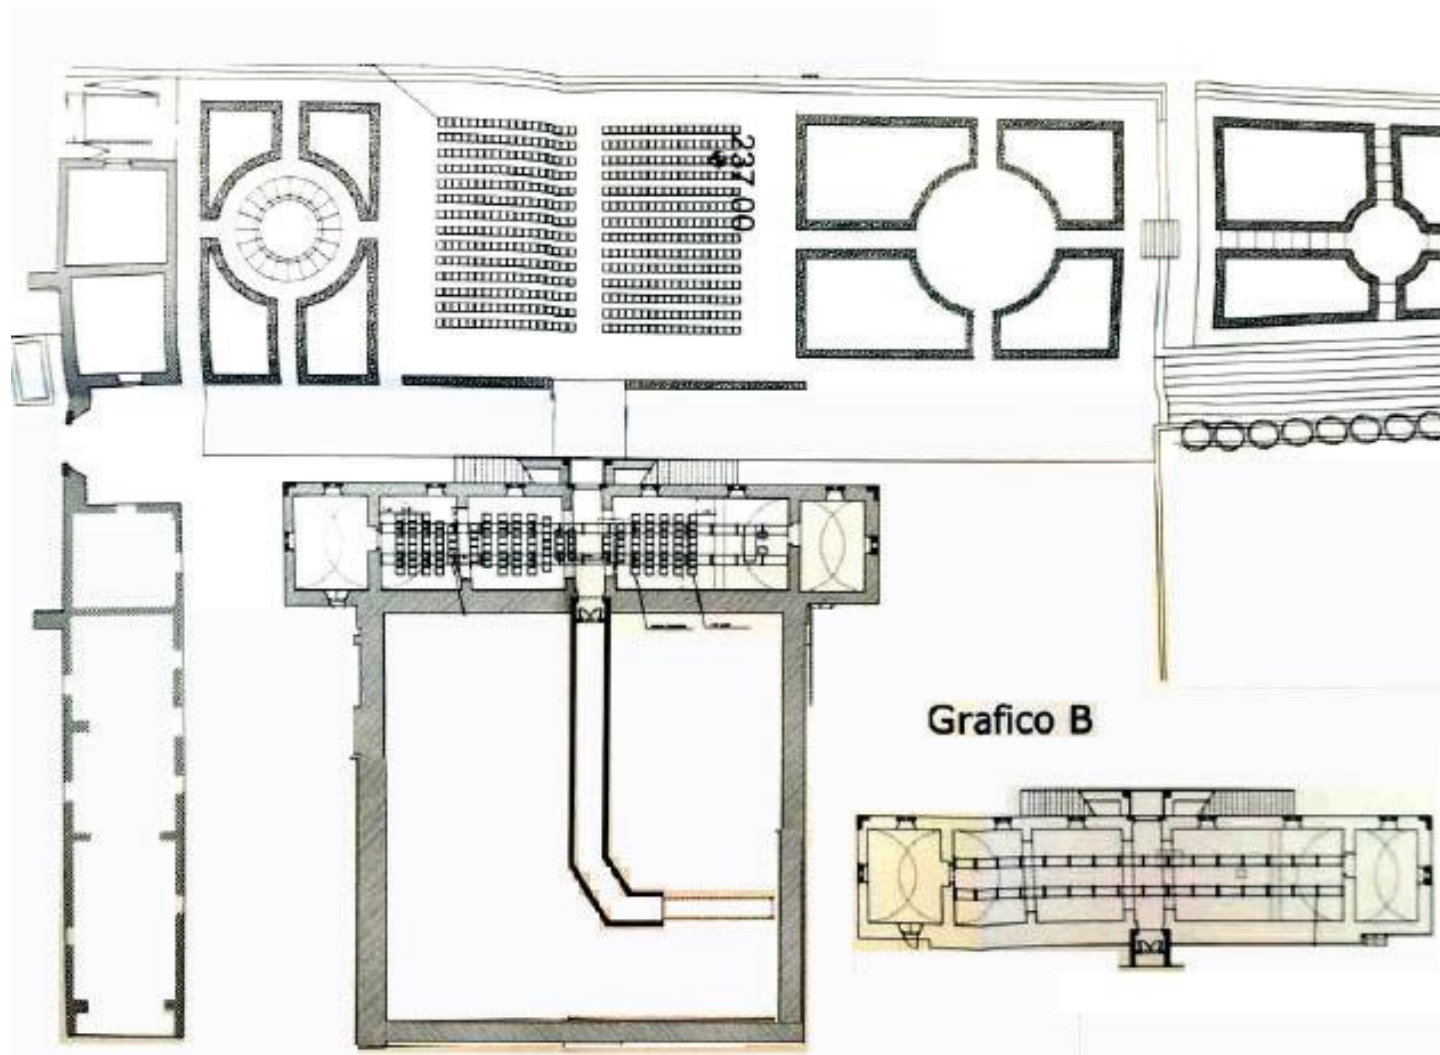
Planimetria della parte sotterranea e le ipotesi di giardino rinascimentale nel progetto dall'architetto Savarese davanti al Palazzo
